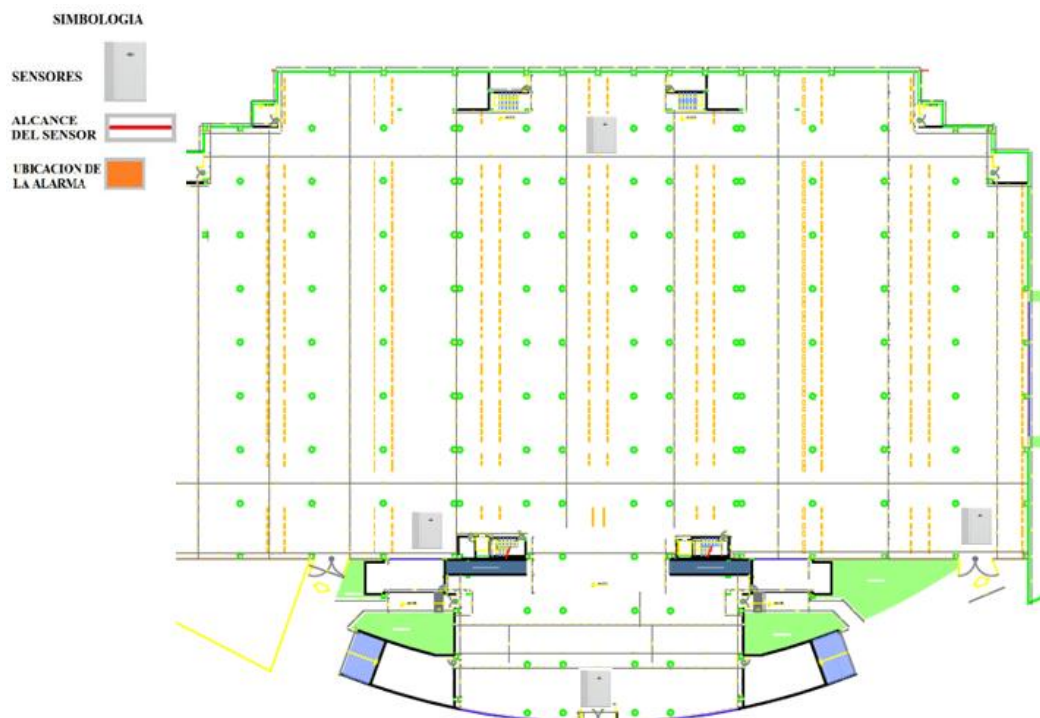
Ubicación del sistema de alarma con sensores en el estacionamiento d la planta baja
